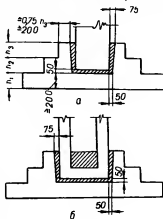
132. Ступенчатые железобетонные фундаменты стаканного типа под сборные колонны:
